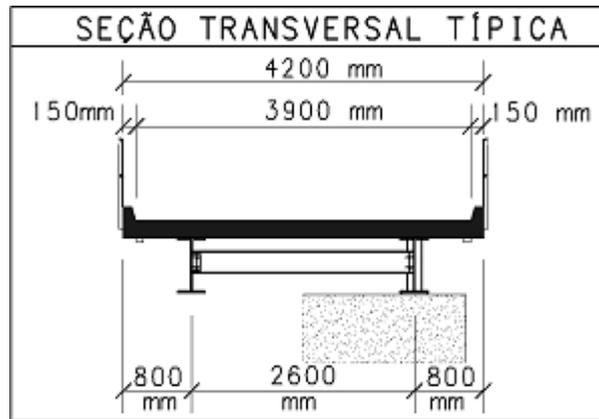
Vista transversal típica considerada para dimensionamento dos elementos
